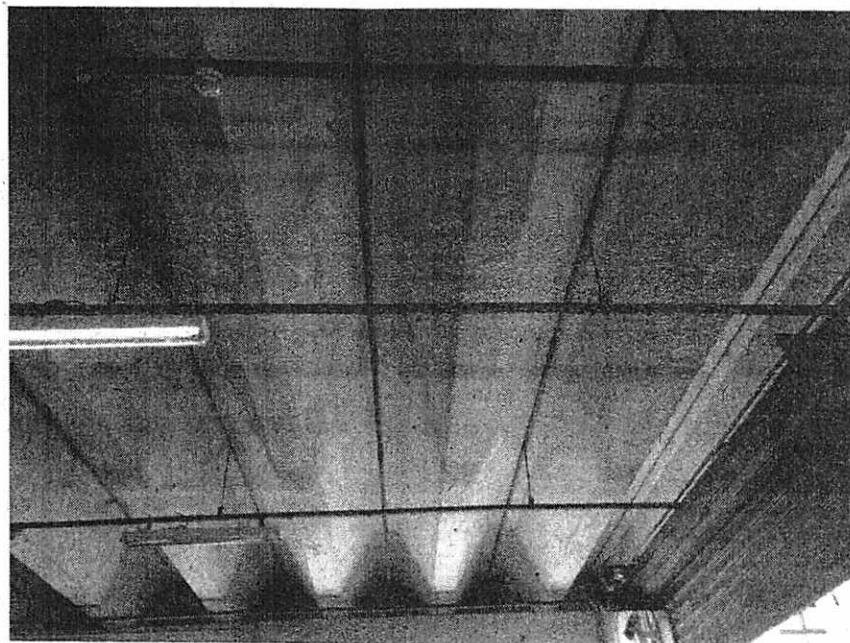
Vista do telhado tipo canaletão apoiadas na estrutura mista de concreto armado/pré fabricado.
